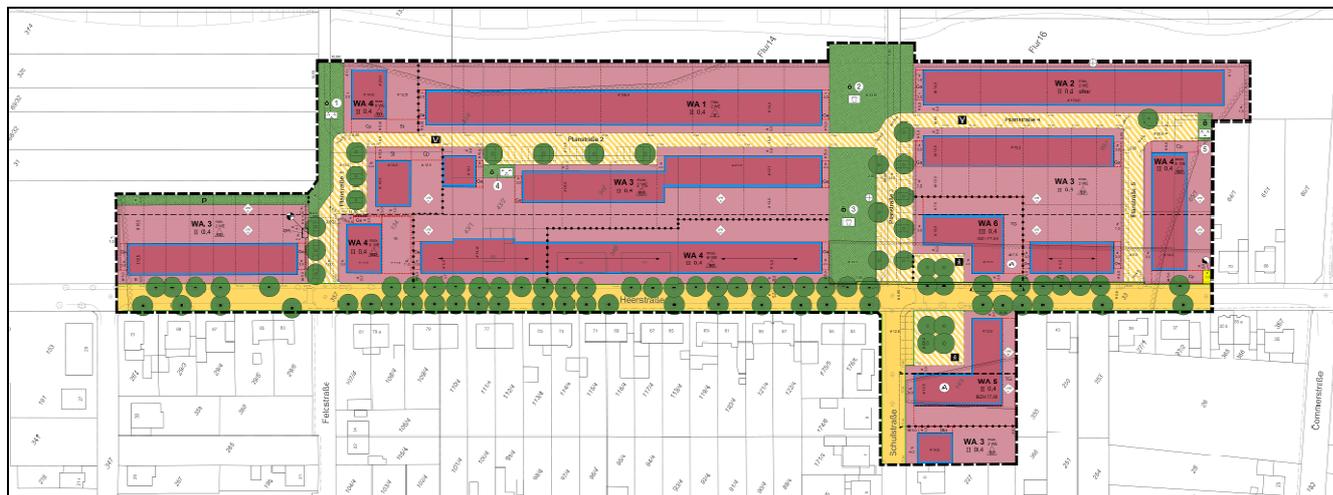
Auszug Lageplan Kreisstadt Bergheim – Bebauungsplan Nr. 266/Bm „Nördliche Heerstraße“ (Quelle: RWE Power AG; Stand 11.05.15)
